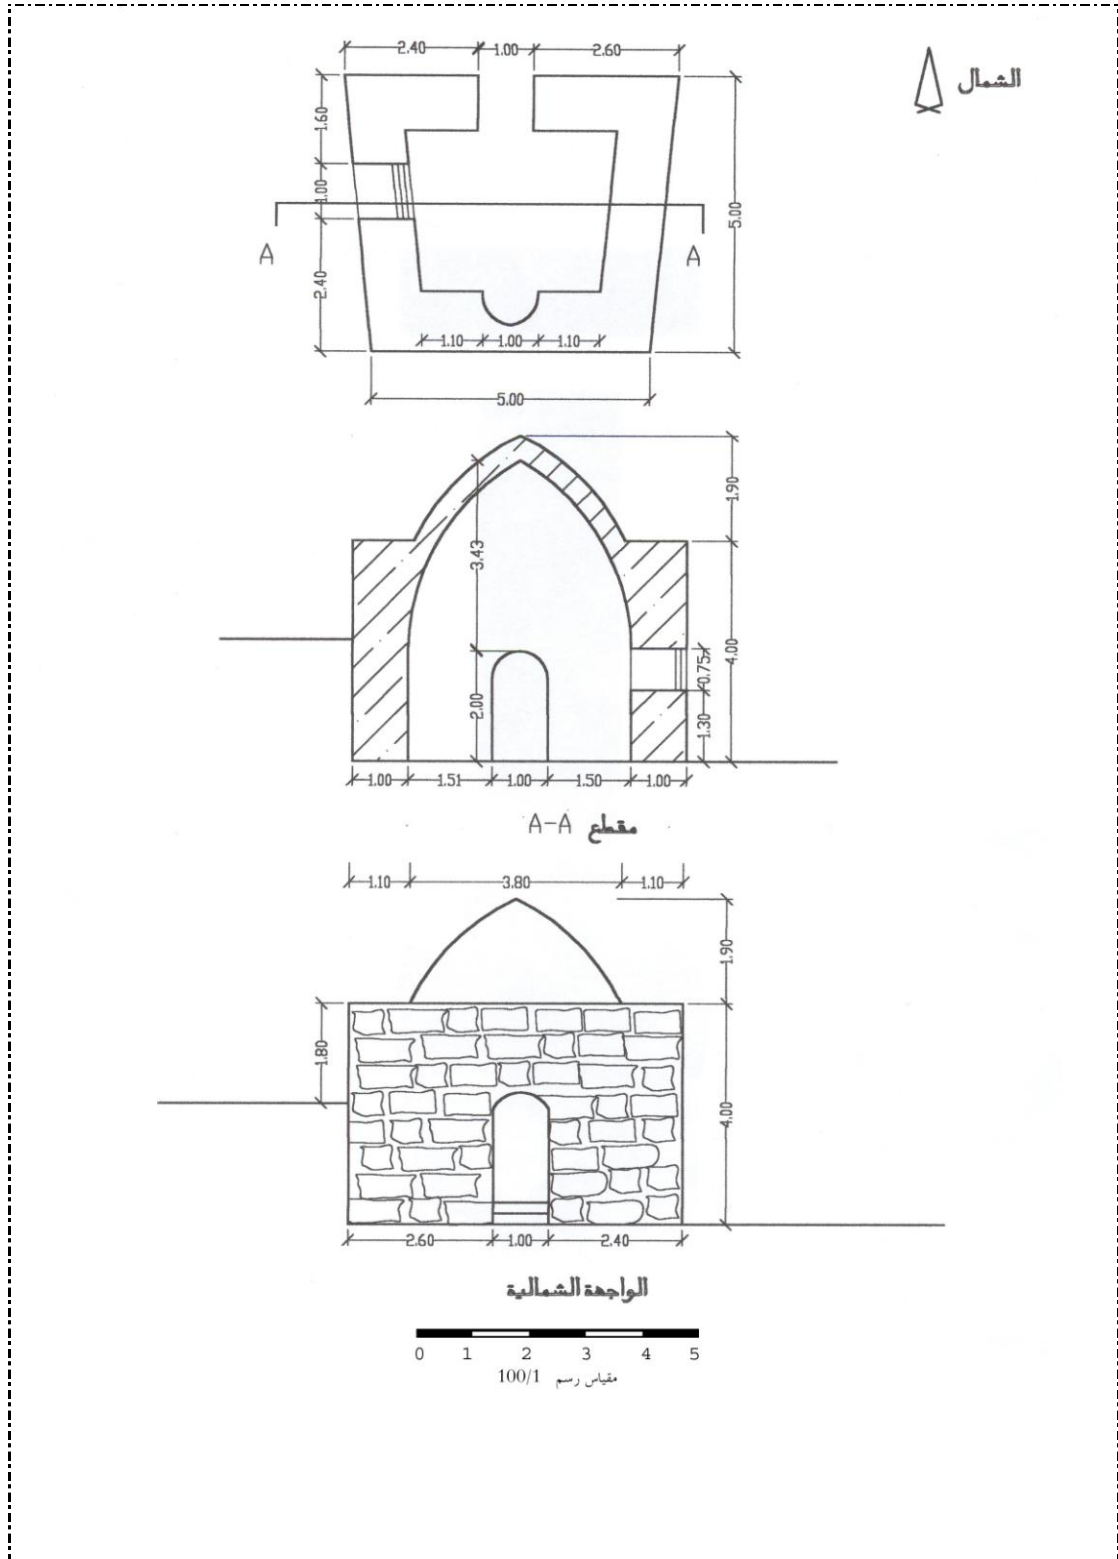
مقام الشيخ عابد في قرية فرخة، مسقط أفقى.
